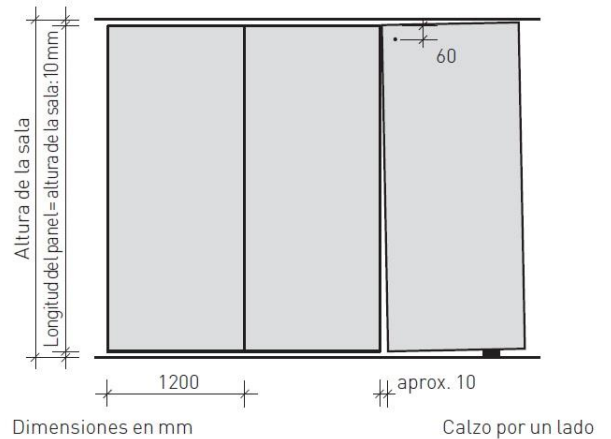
Instalación de las placas por junta pegada calzadas por un lado.
